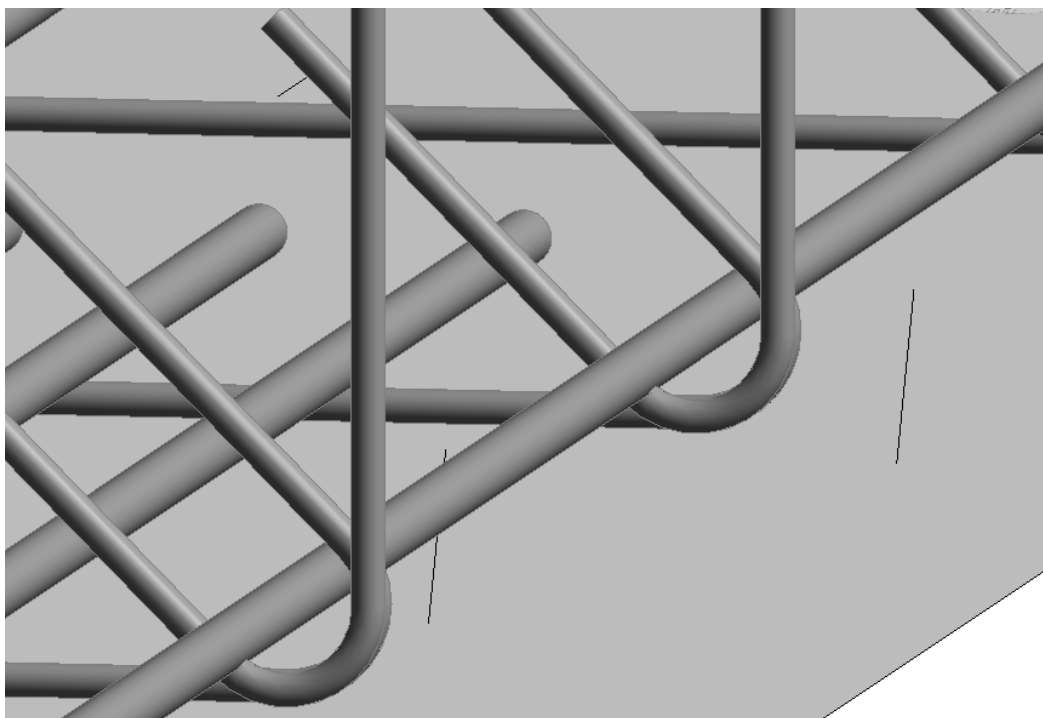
Vista aproximada das armaduras geradas automaticamente pela ferramenta desenvolvida
